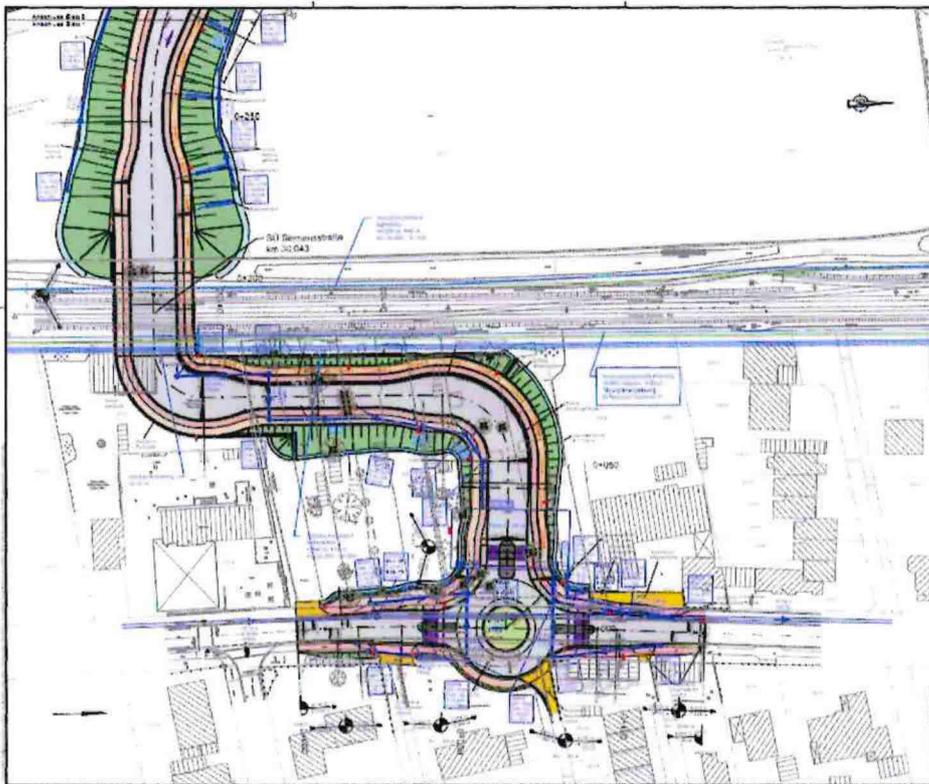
Entwurfsplanung – Bahnübergang und KVP Siemensstraße²⁴
